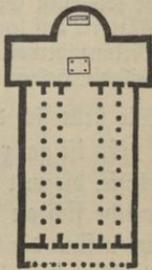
Grundriss der Basilika San Paolo zu Rom.
